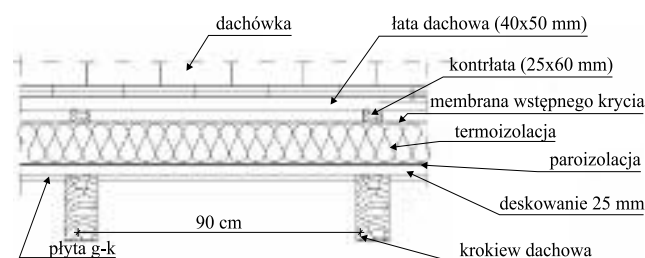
Przekrój pionowy przez dach skośny z warstwą izolacji pod krokiewiami
